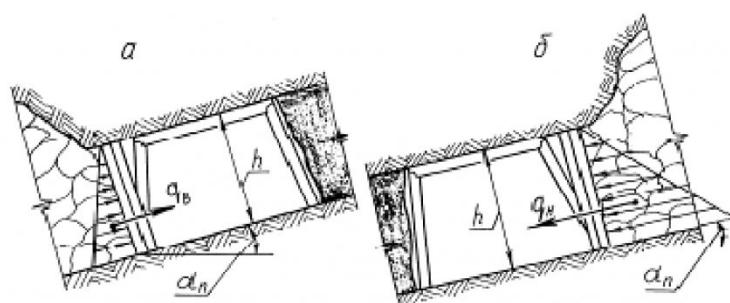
Схемы к расчету боковой нагрузки на крепь сохраняемой подготовительной выработки: а – восходящий, б – нисходящий
